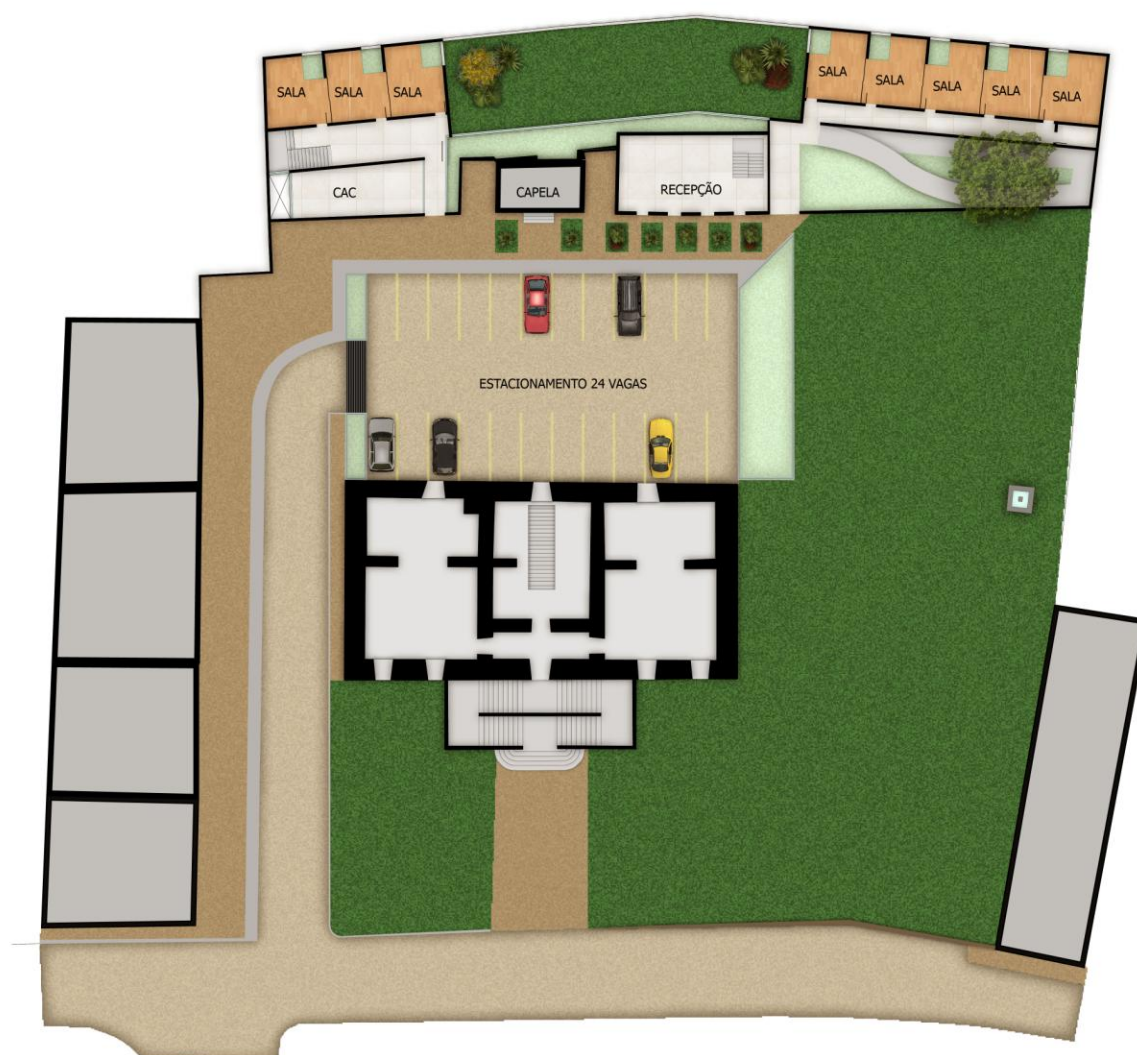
Planta do 1º pavimento do Anexo da Câmara Municipal de Mariana
